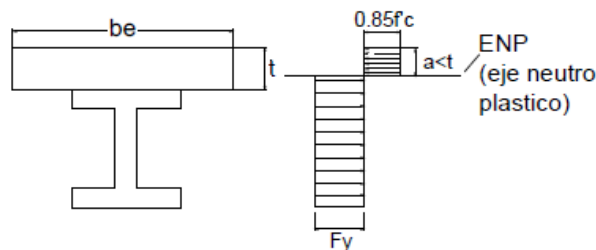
Viga compuesta con ENP en la losa (Johnston L., 1999)
